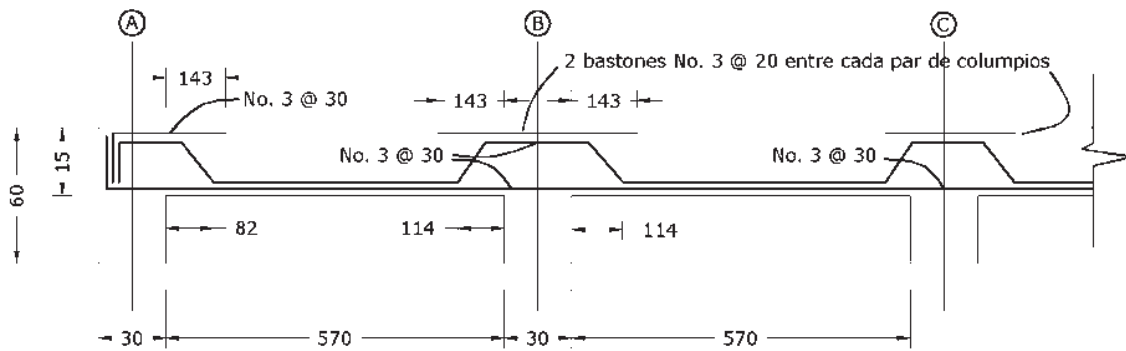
Croquis de armado de la losa de los modelos estructurales
